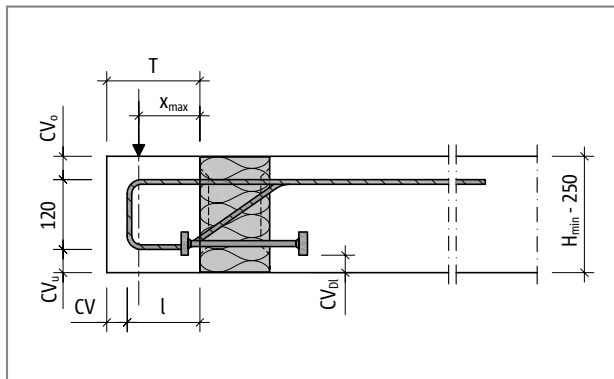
Schöck Isokorb® XT Typ O: Produktschnitt
